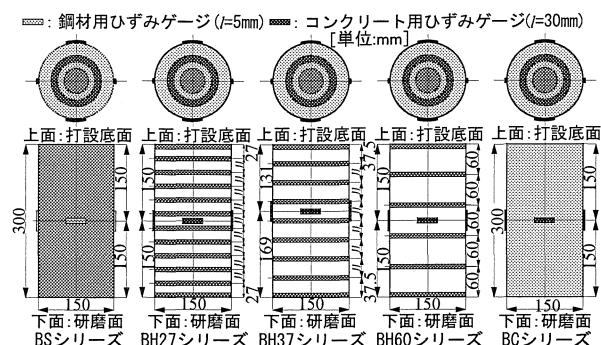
試験体の形状・寸法・ひずみゲージ貼付位置
